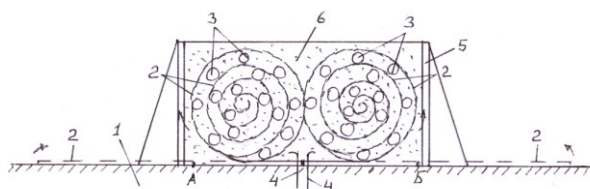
Конструкция двойной спиральной многоканальной трубы: 1 – основание; 2 – арматурный каркас (геосетка); 3 – полимерные трубы; 4 – костыль; 5 – опалубка; 6 – бетонная смесь
